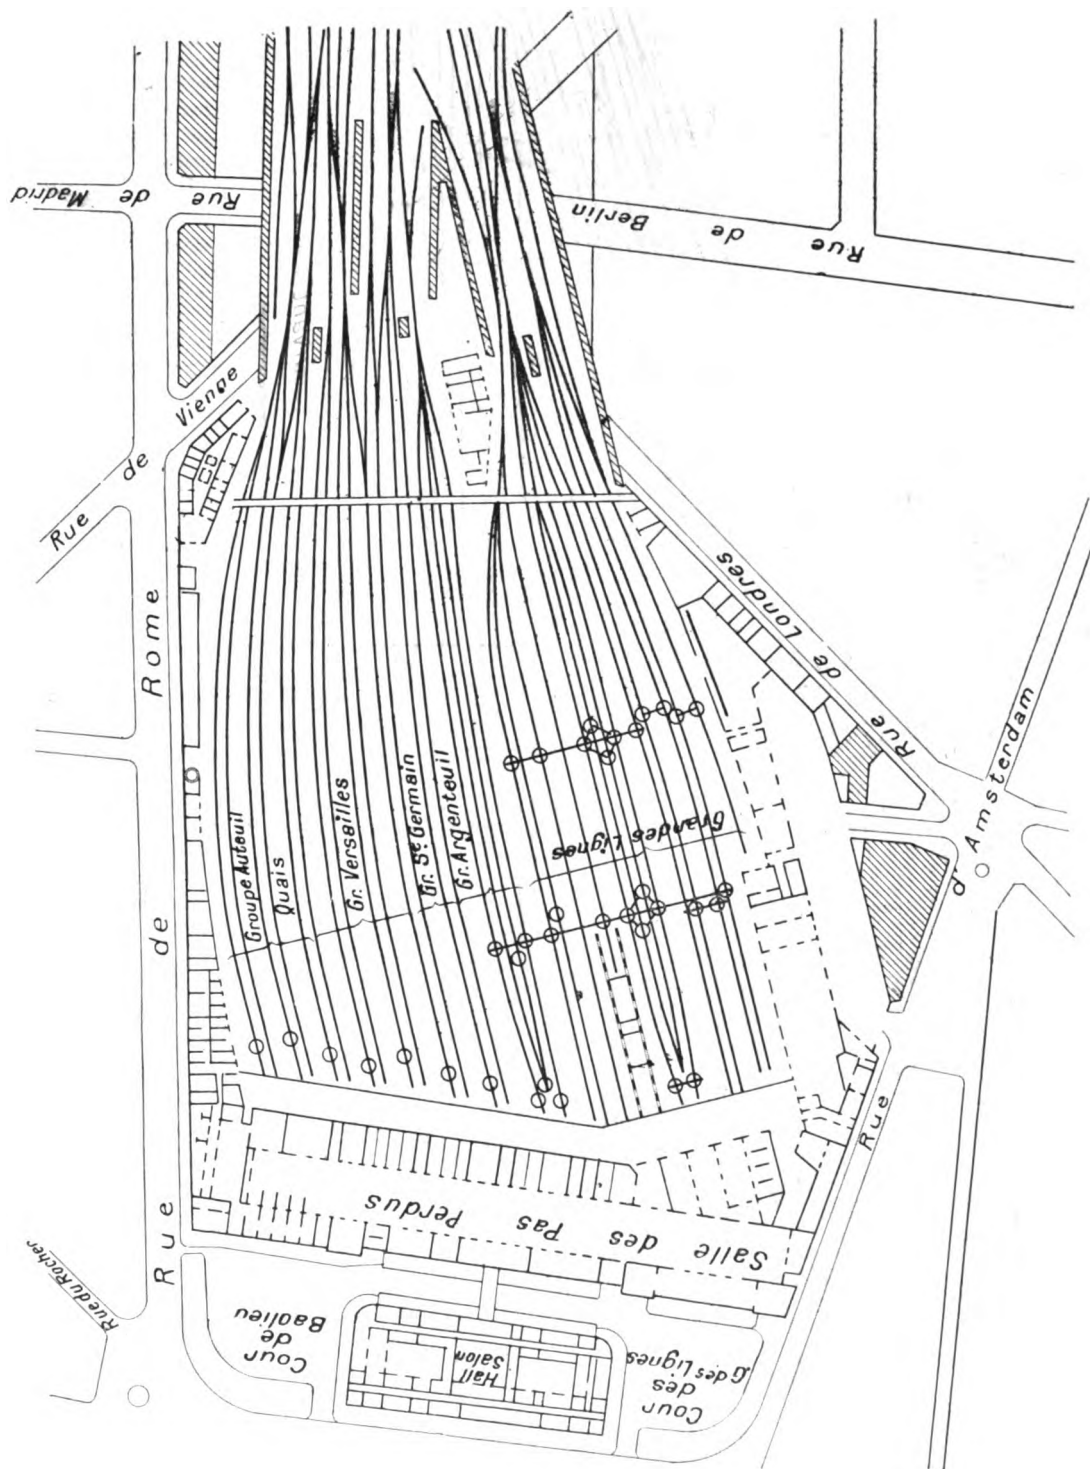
Plan de la gare Saint-Lazare actuelle.
